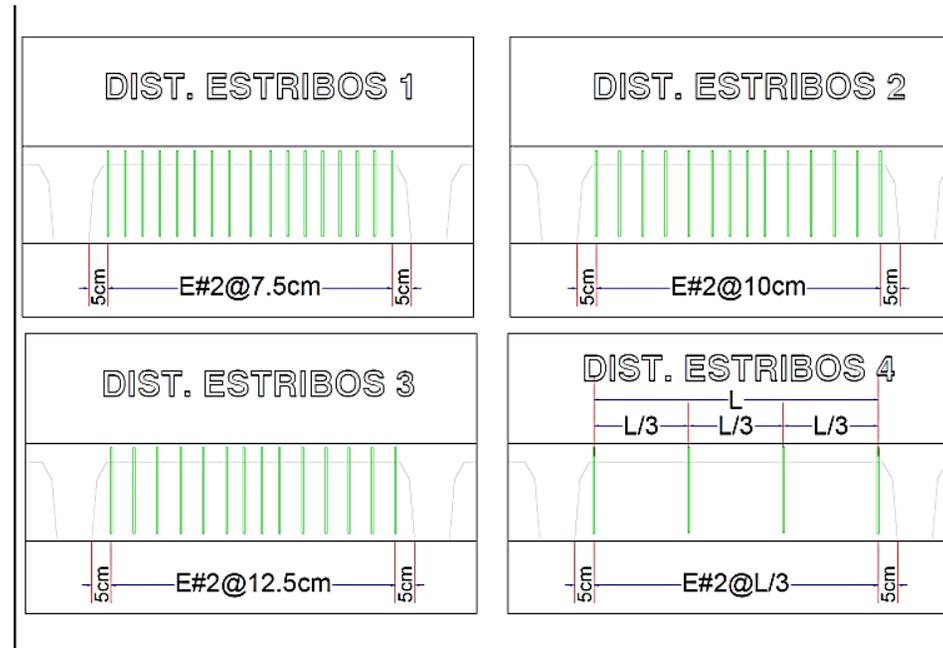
Plano estructural losa tipos de distribución de estribos.
